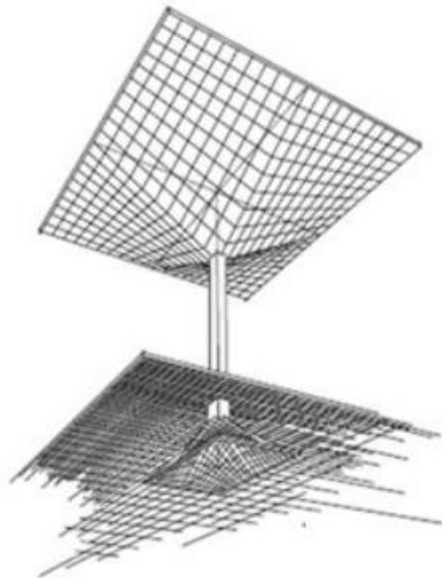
Croqui da fundação e cobertura do terminal ferroviário da estação de metro Ana Rosa (Medrano, 2013)
